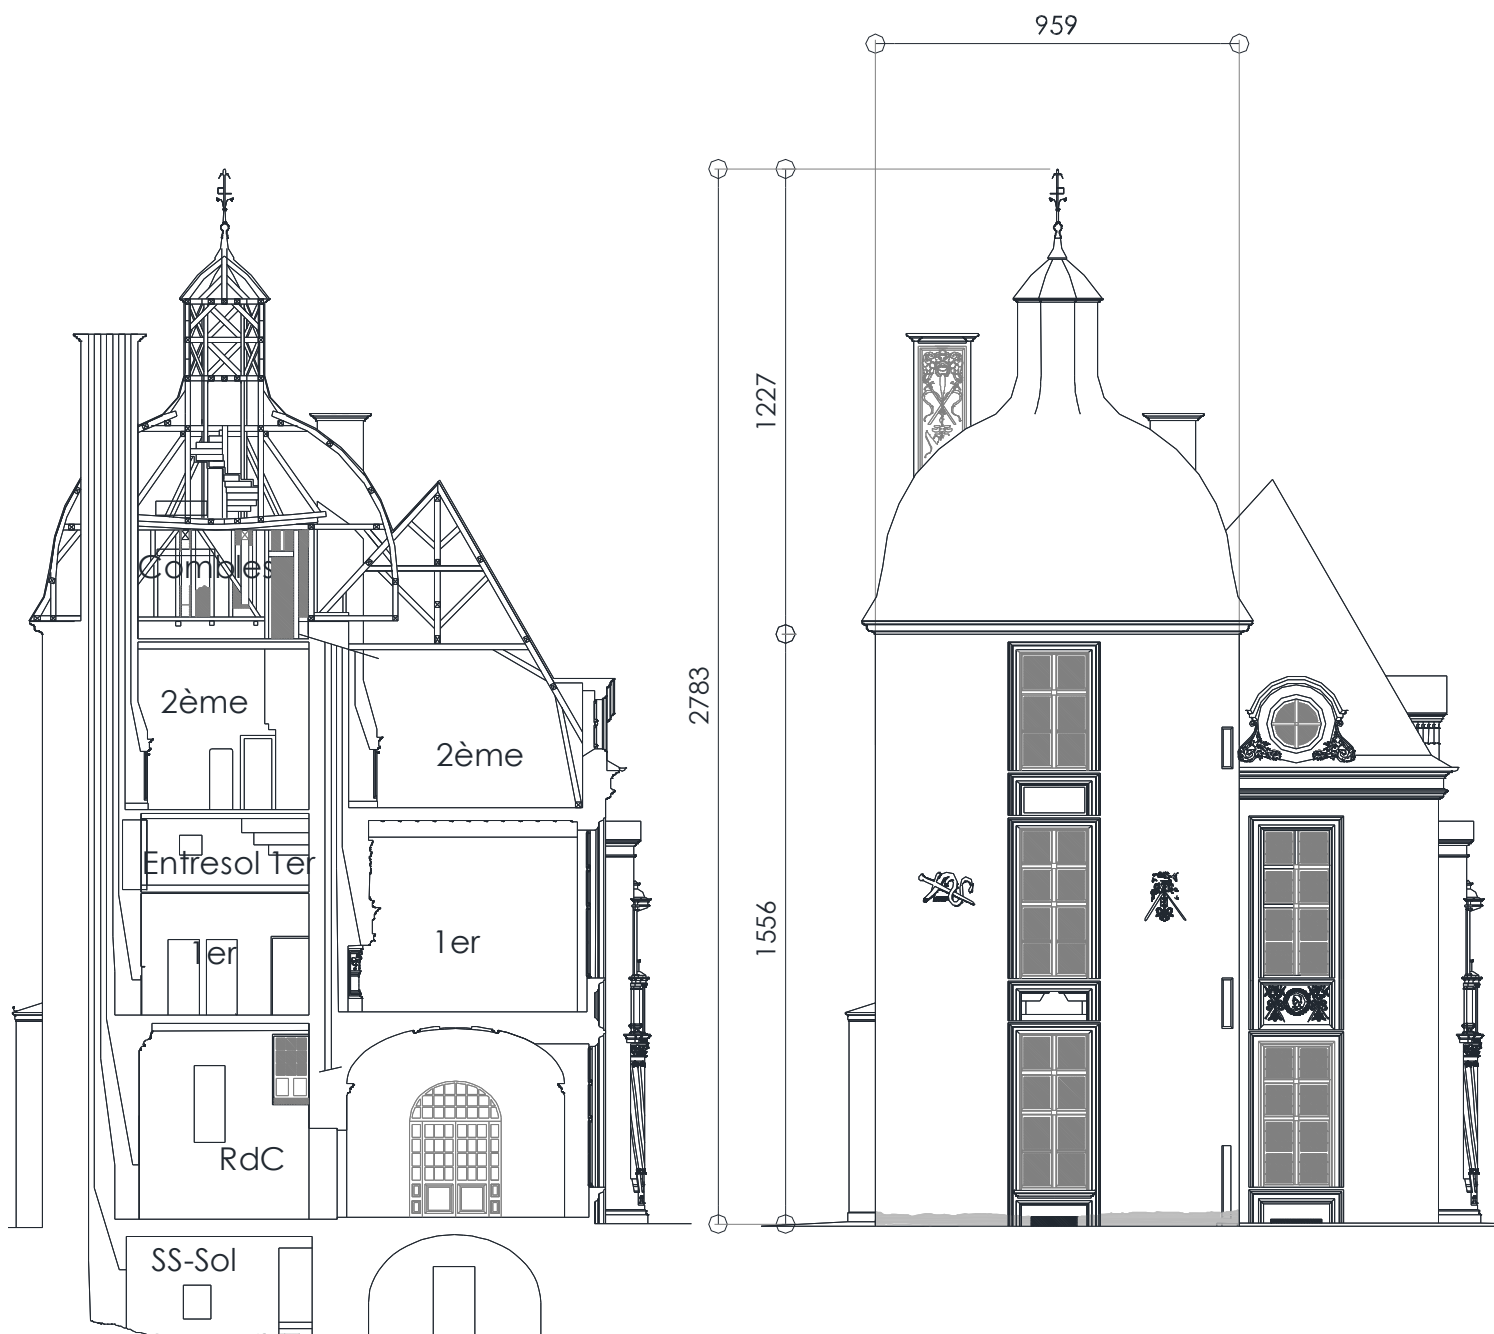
Elévation de la façade Nord de la tour de l'épée et coupe Est-Ouest - Extrait plan O.Salmon - ACMH
